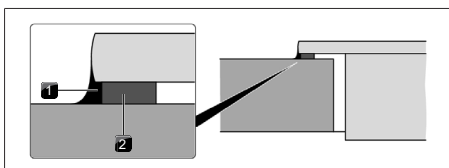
Cinta selladora en caso de montaje superpuesto
